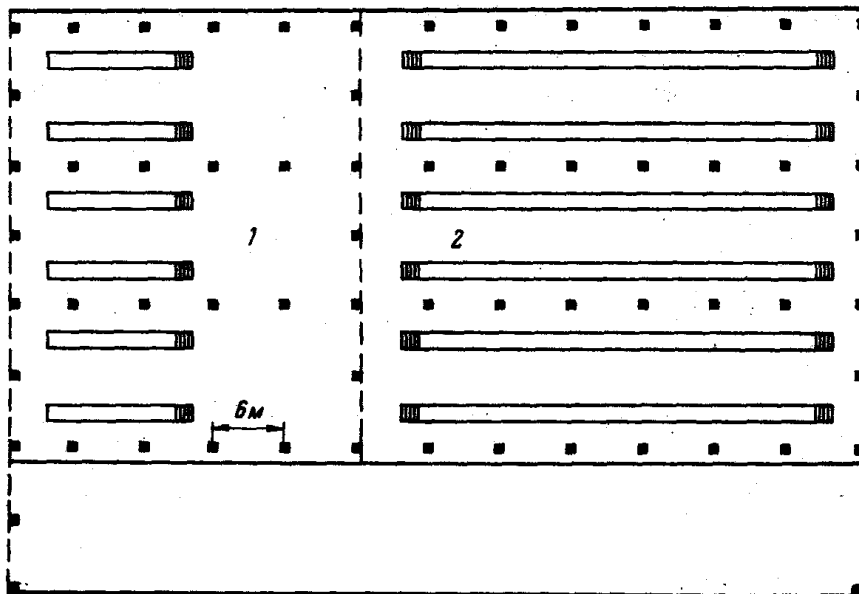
Фрагмент планування цеху ТО:
